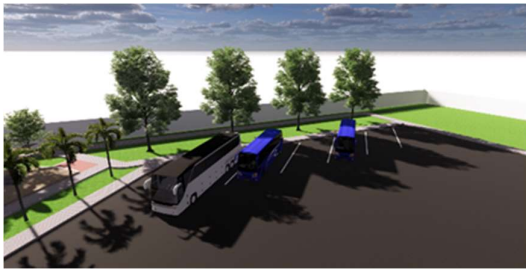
Area Parkir Untuk Pengelola Dan Pengunjung Terminal
